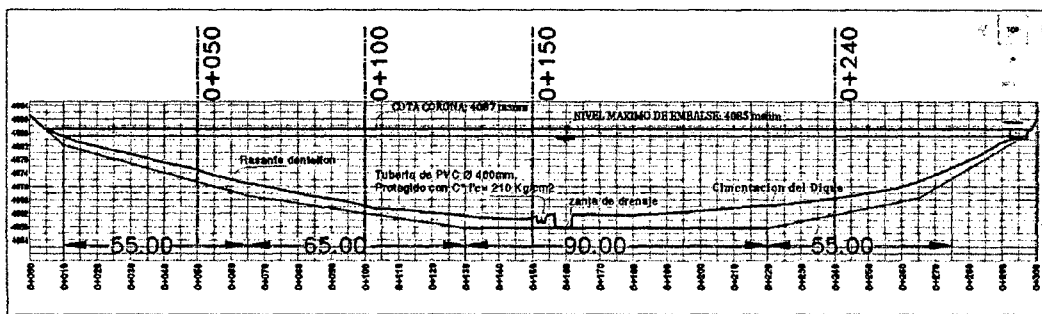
Perfil Geotécnico (Cierre de la Presa)
